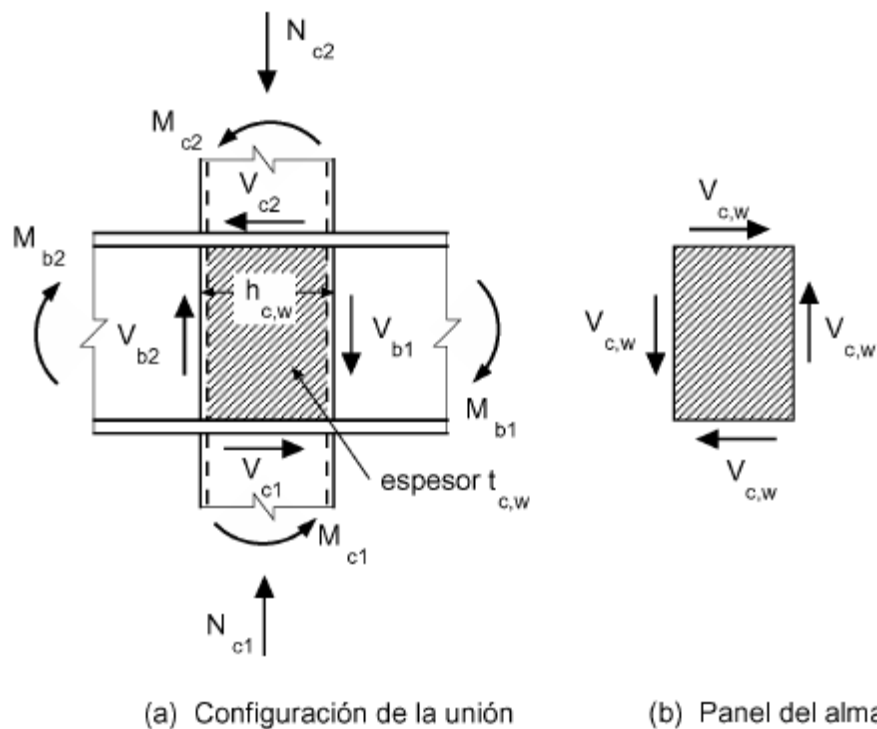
Panel del alma de la columna enmarcado por alas y rigidizadores [15]
